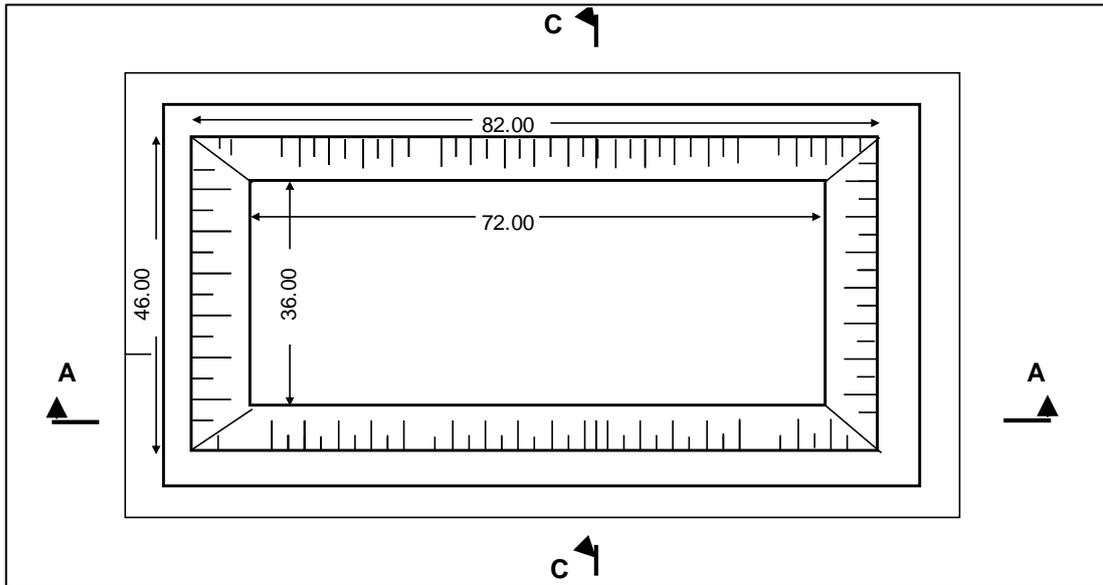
Dimensionamiento en planta de la laguna de oxidación secundaria.
